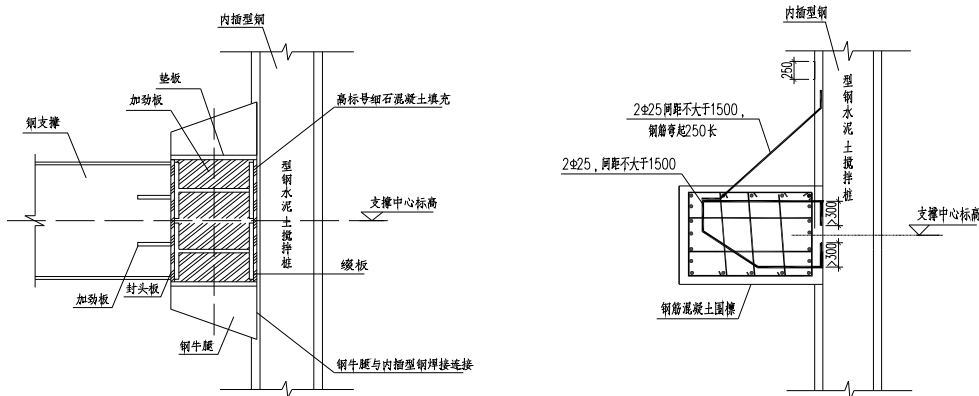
型钢与钢腰梁及支撑连接示意图 13-10 型钢与混凝土腰梁连接示意图
